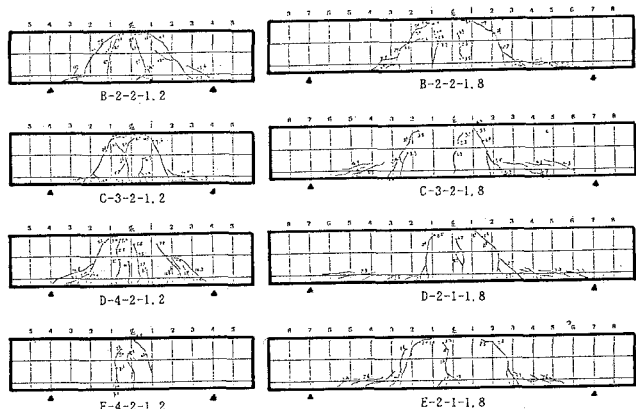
破壊時のひび割れ状況 (1) 図-3 破壊時のひび割れ状況 (2)
